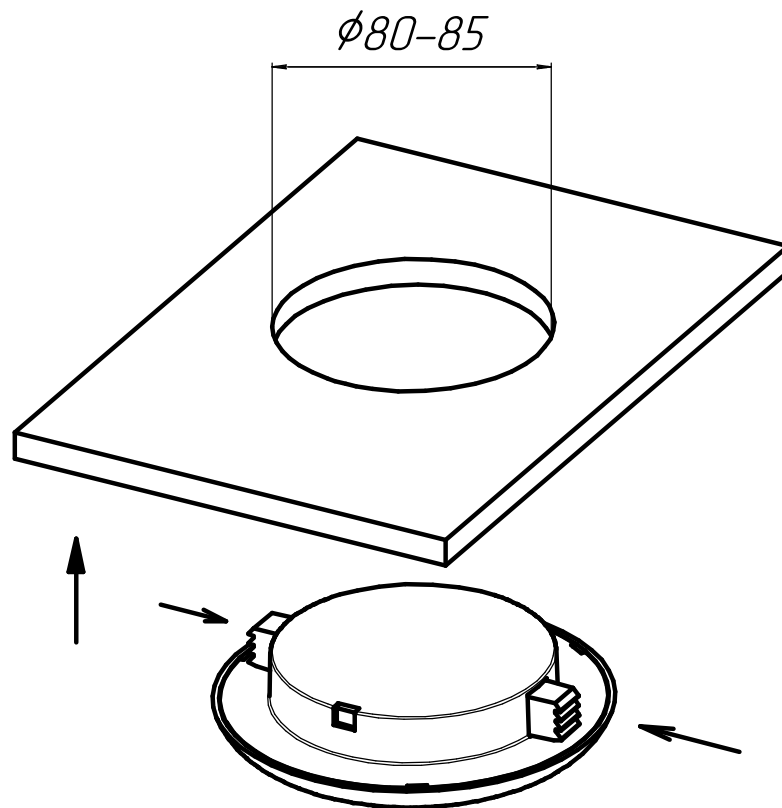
Схема монтажа светильника в подвесной потолок;
